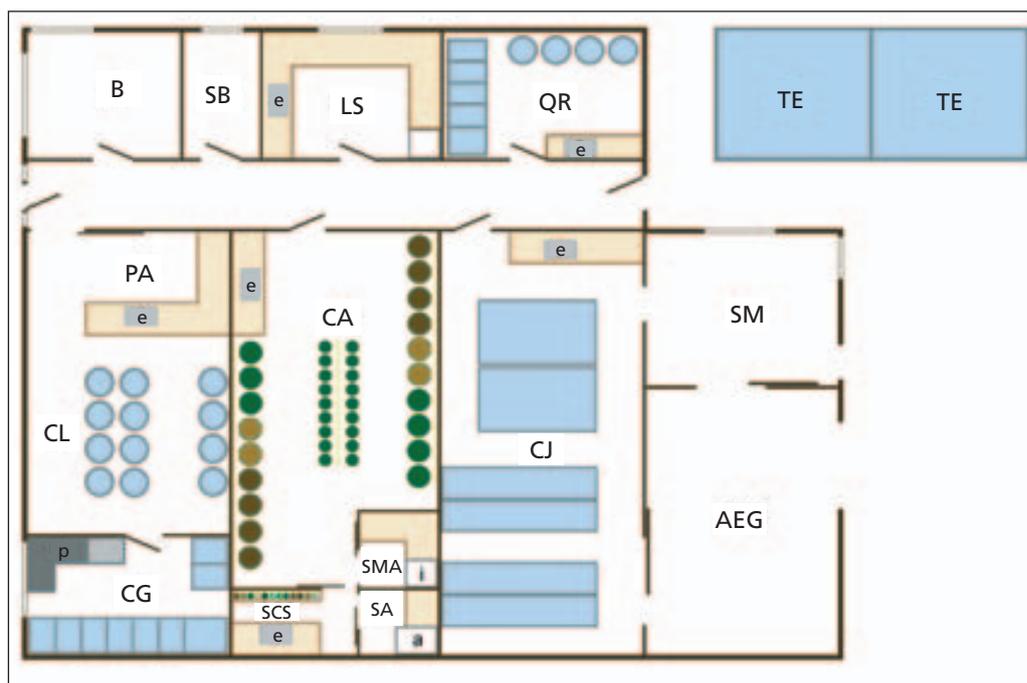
Plan général pour la construction d'une écloserie de bivalves (voir le texte ci-dessous pour explication).
